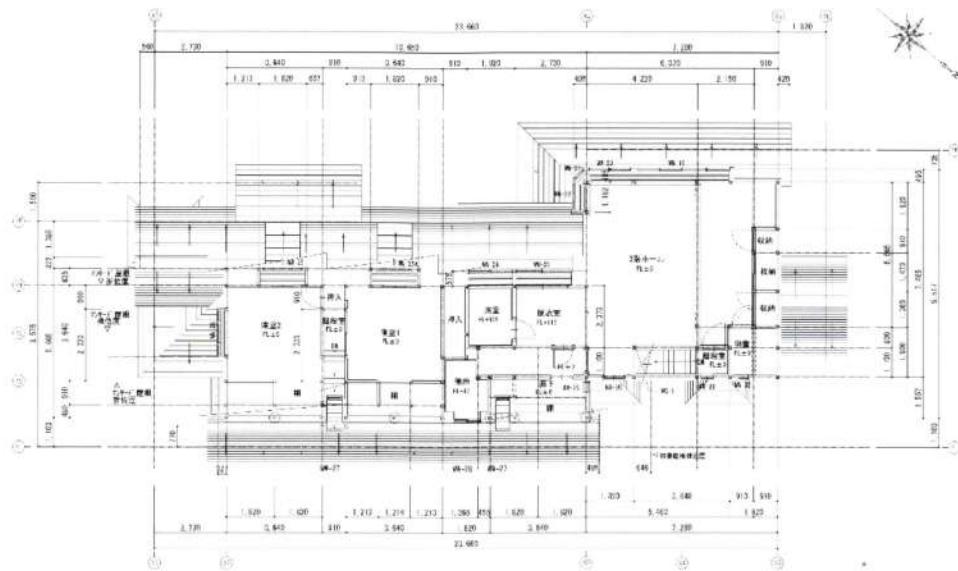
研究室 2 階平面図 (株式会社シン技術コンサル提供)
